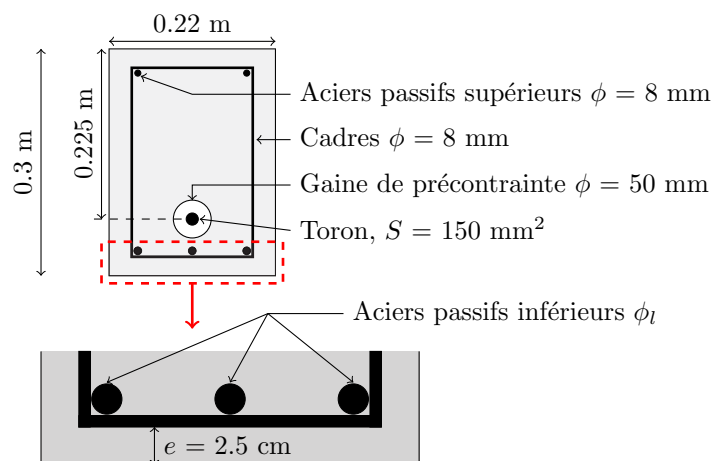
Géométrie de la section transversale des poutres précontraintes testées.
